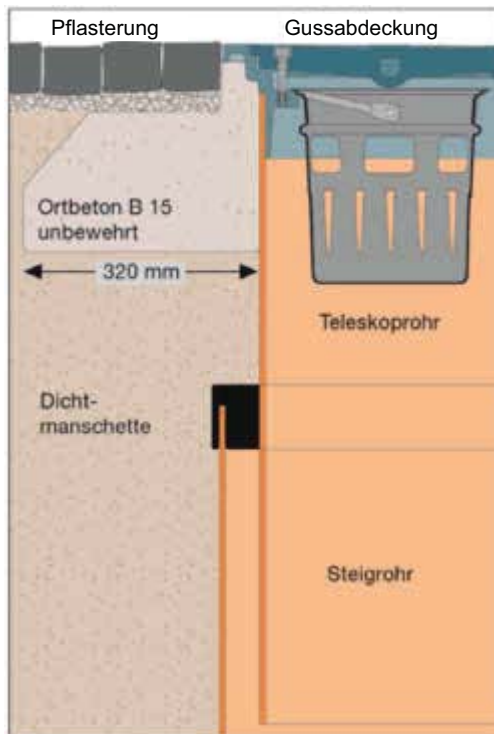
Einbau Inspektionsöffnung (Kontrollschacht) DN 400 mit Betonaufleger für die Schachtabdeckung zur Aufnahme der Lastabtragung aus Verkehrsbelastung
